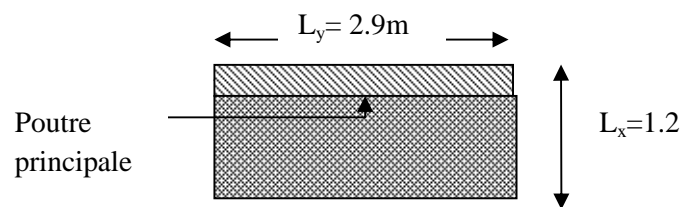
Schéma d'une dalle sur 1 appui.
